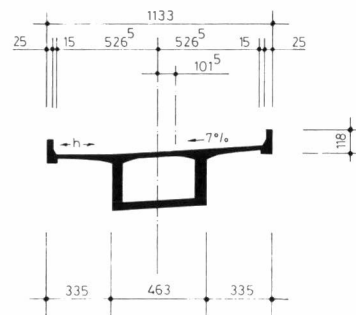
Querschnitte – Coupes en travers – Cross sections
